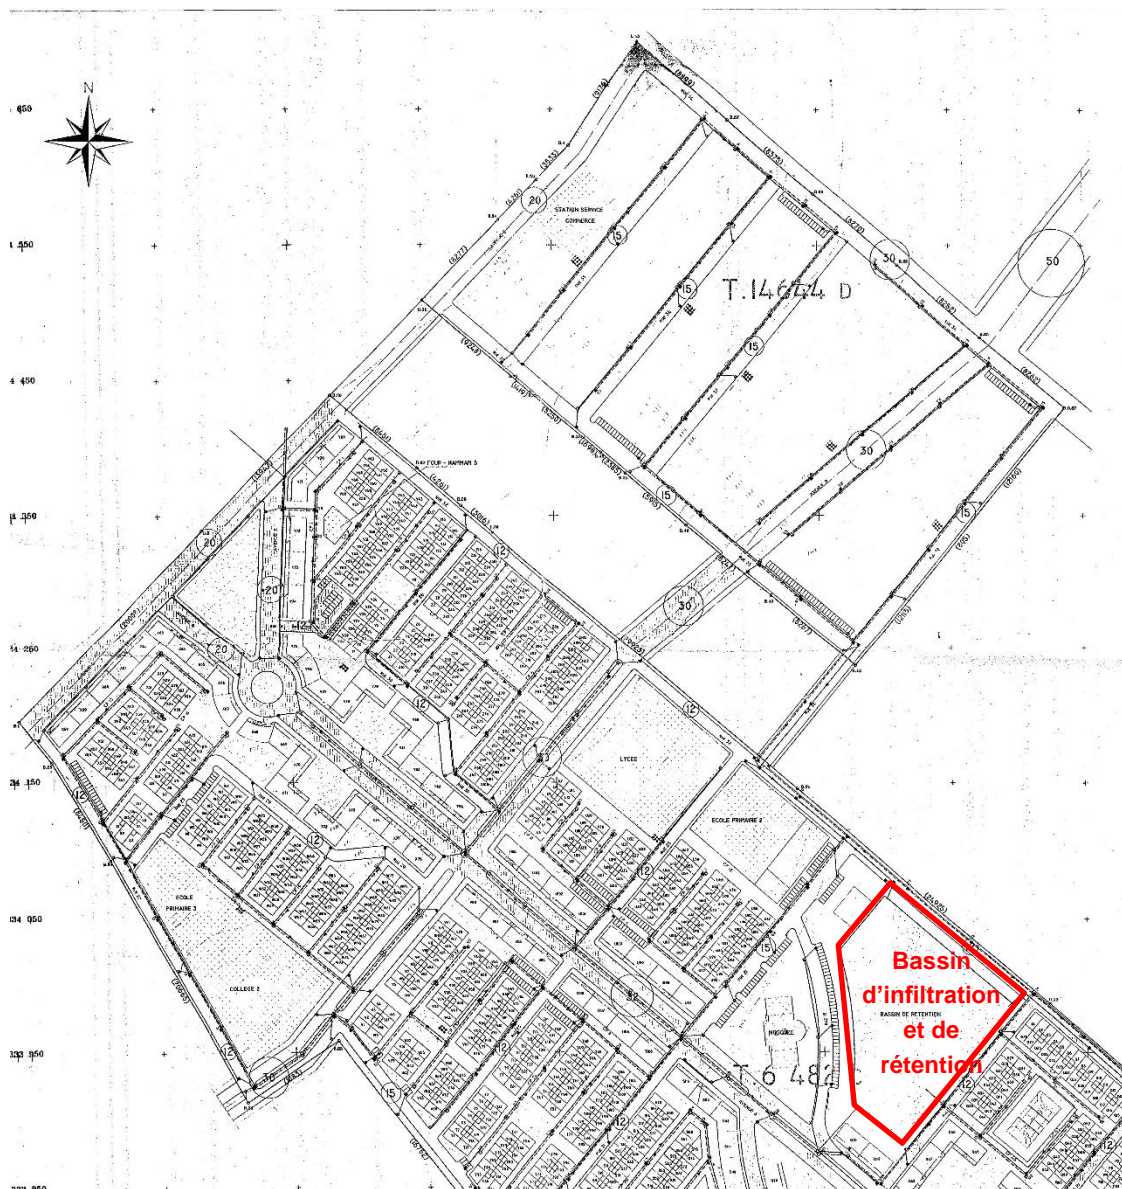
Plan de récolement des réseaux d'assainissement existants du parc industriel d'Ahl Loughlam (source : AIOmrane, 2008)
